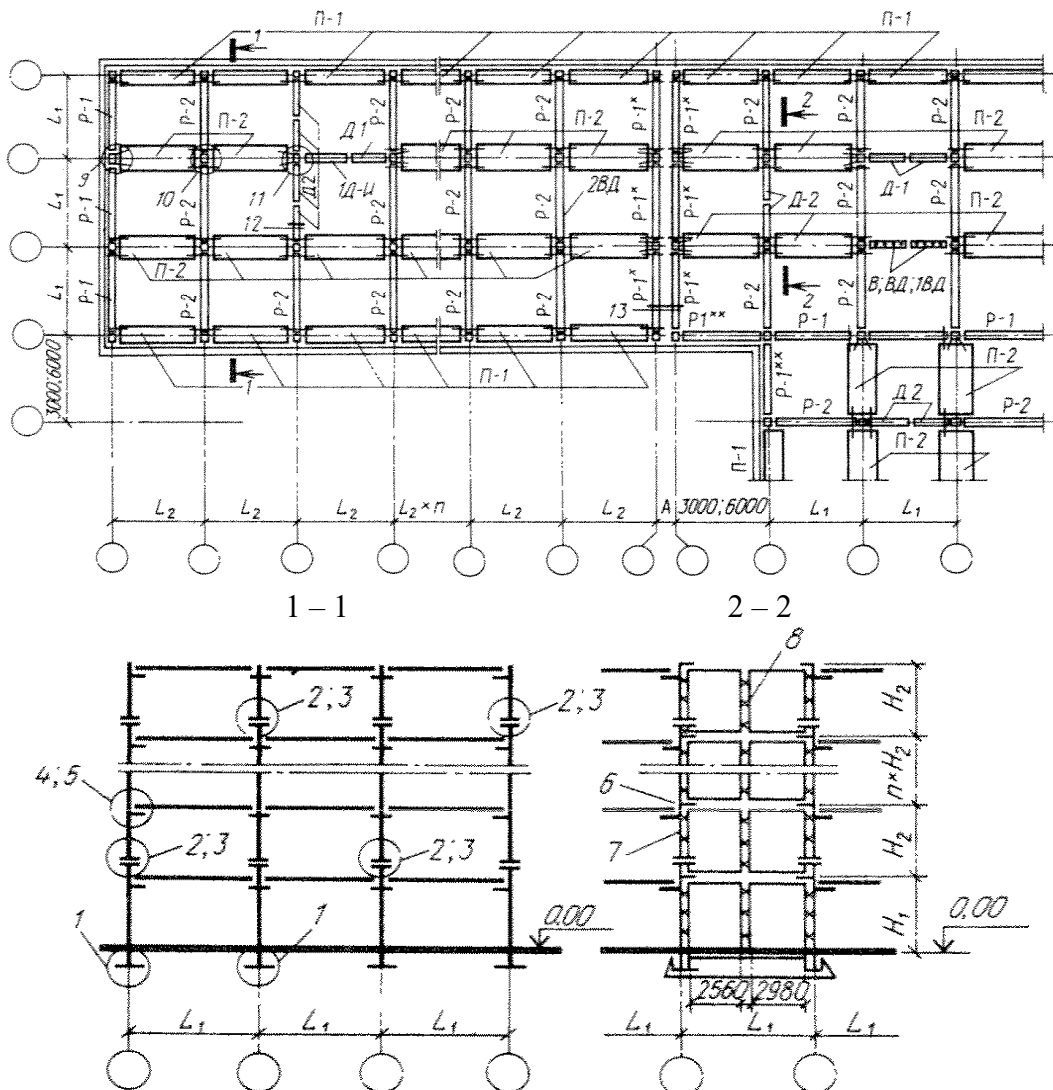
Варианты расположения ригелей и плит перекрытия
